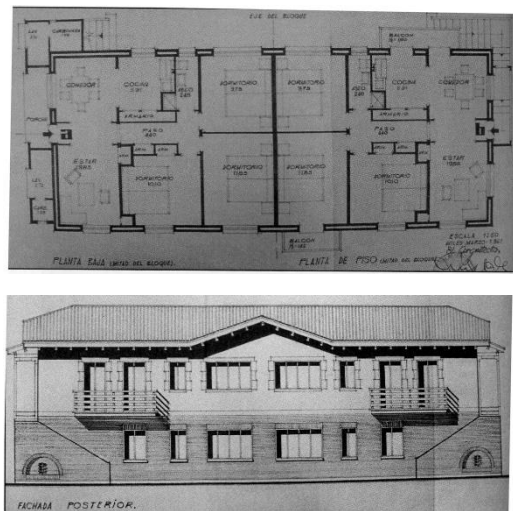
Planta y fachada posterior de chalet de cuatro viviendas. Jardín de Cantos. 1961.
